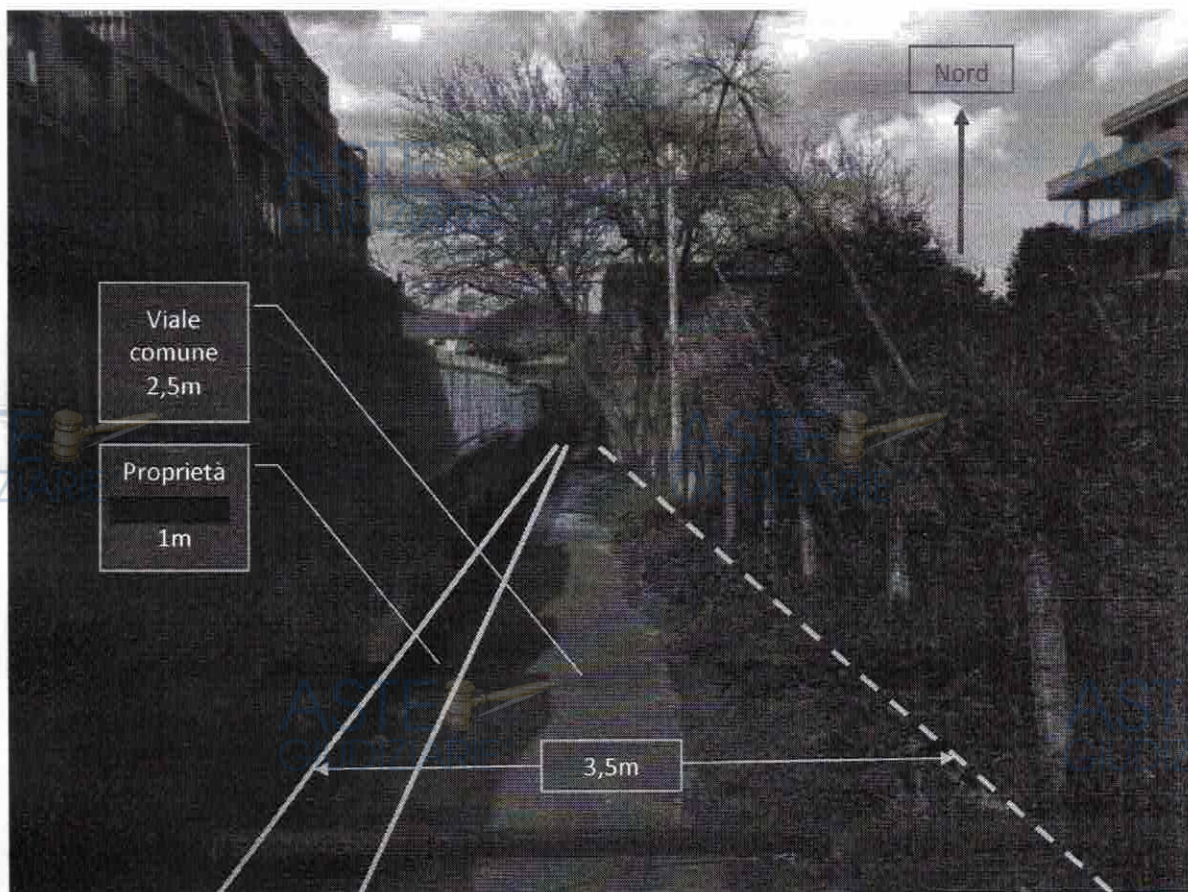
strada sterrata con indicazione delle dimensioni rilevate
